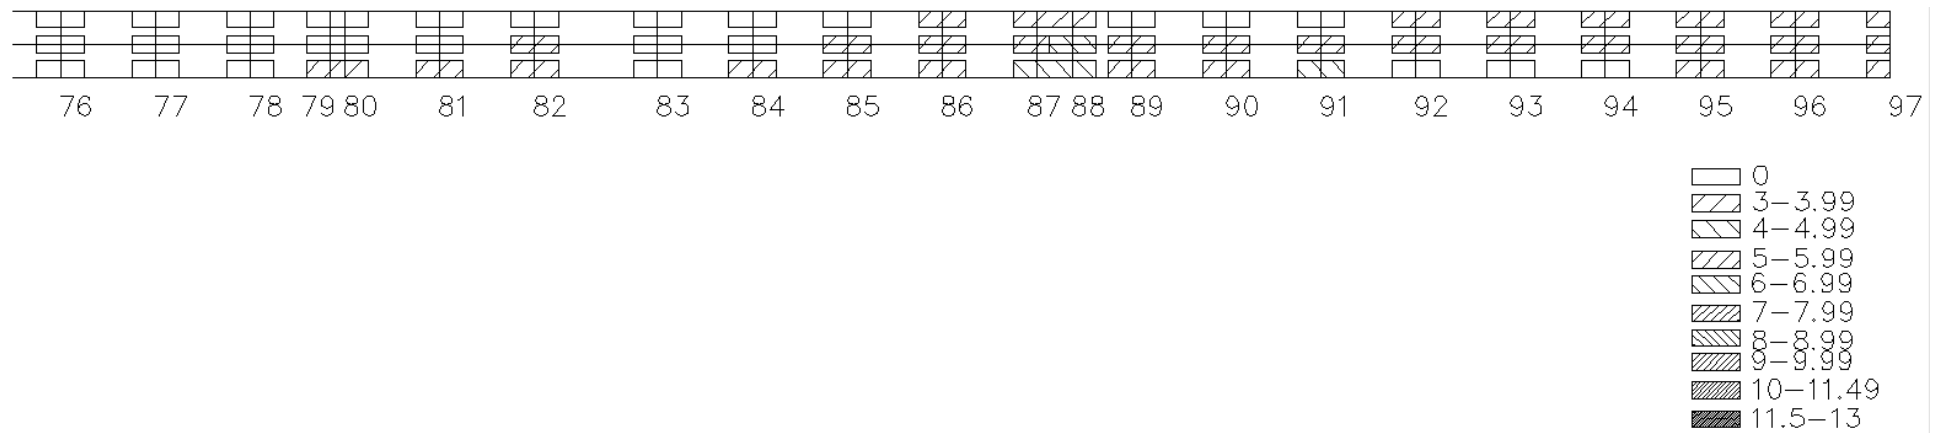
Ausgleichungsdicke bei kubischer Splinefunktion und Verfahrensplan Typ V, Grundriss, Stationen 76-97
